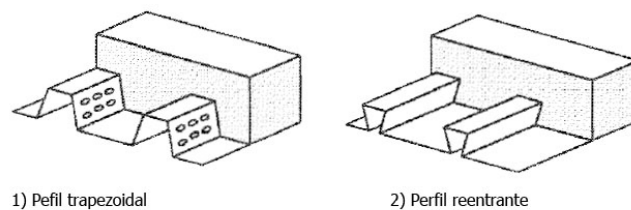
Tipos de chapas perfiladas (adaptado de [2][1])
